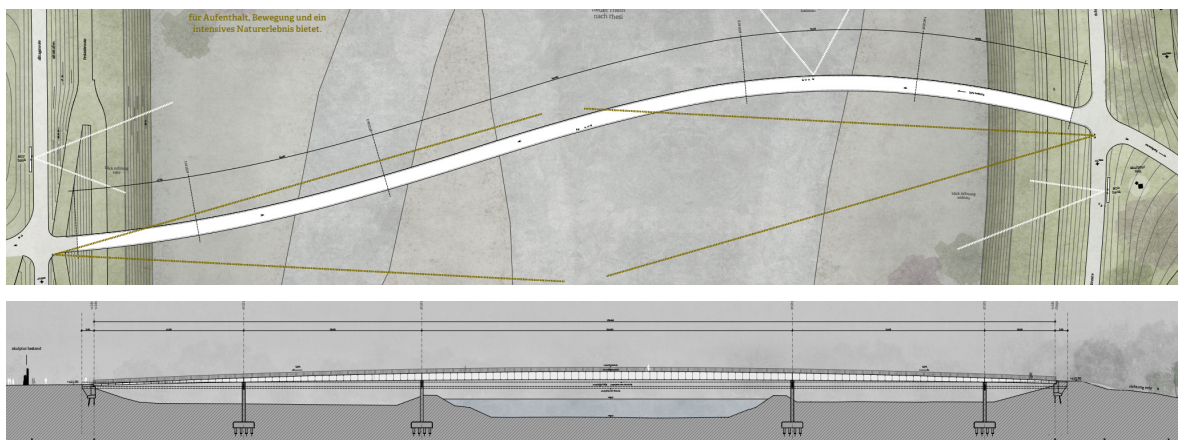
Grundriss und Längenschnitt der Brücke (Auszug aus Projektunterlagen sbp / Bernardo Bader / Lars Ruge Landschaften, vom Juni 2025)
